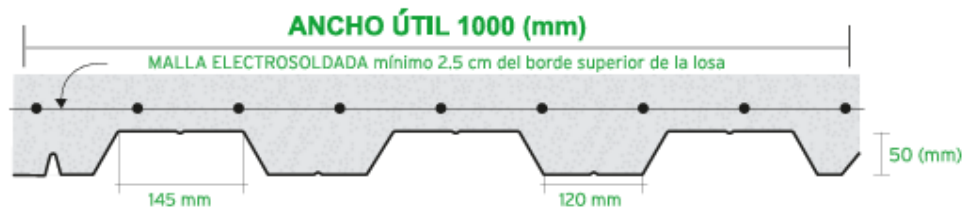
Dimensiones placa colaborante (KUBIEC, 2024).
